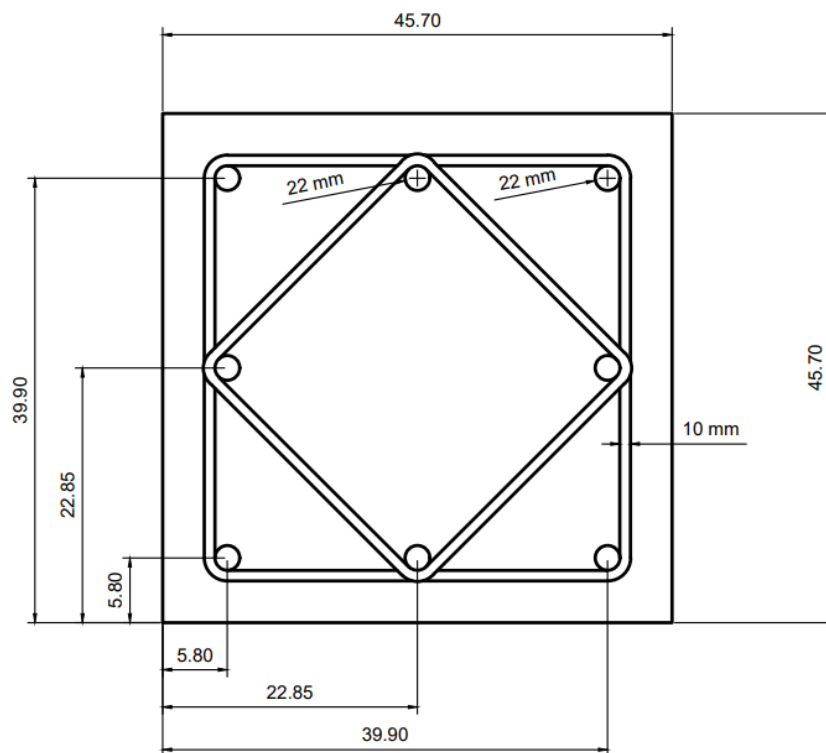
Seção transversal dos pilares com o detalhamento de suas armaduras, medidas em cm.
